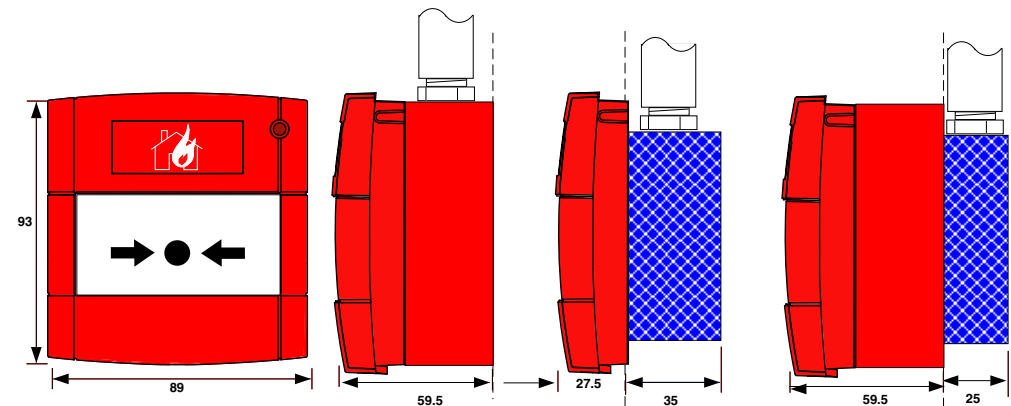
FC420CP-I Dimensioni di fissaggio complessive
